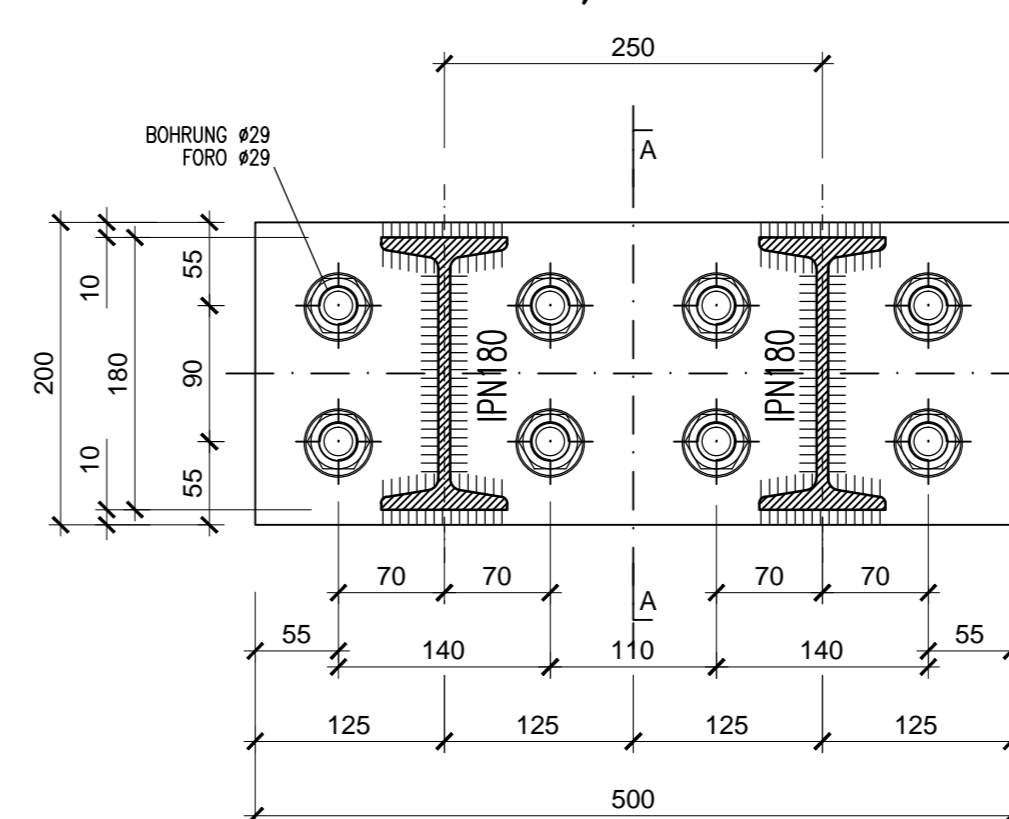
DETAIL VERBINDUNG STAHLBÖGEN (Verbindungseisen Ø22)
